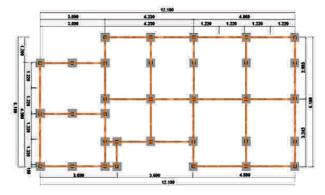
48 : Plano de vigas principales que amarran las cabezas de los pilotes, conformando el plano horizontal de la plataforma de madera.
